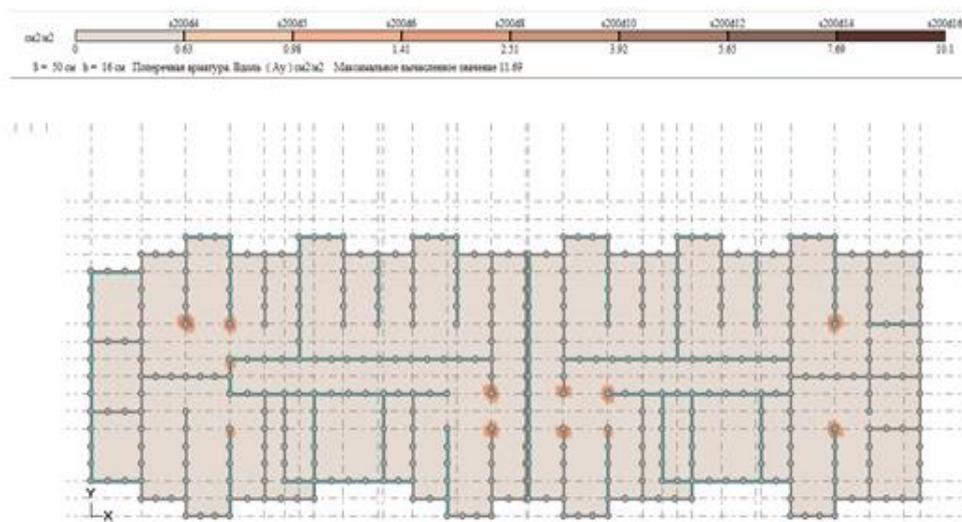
Площадь поперечного сечения, диаметр и шаг вертикального арматурного стержня
